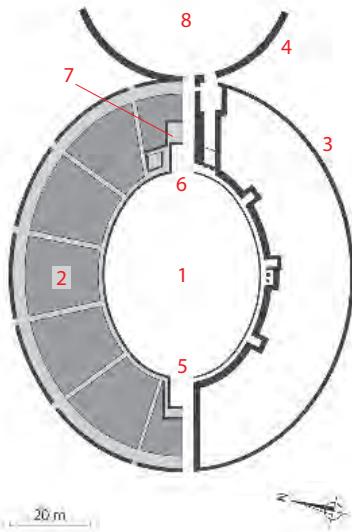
Amphitheater. Grundriss der ursprünglichen Bauphase (Anfang 2. Jh. n. Chr.); links Aufsicht, rechts Plan auf Fundamentniveau.
